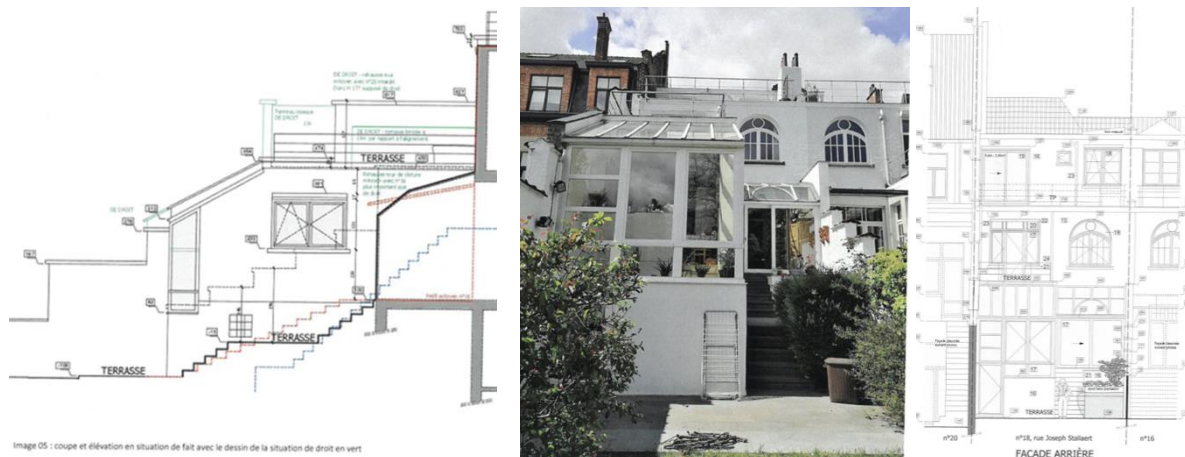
coupe et élévation en situation de fait avec le dessin de la situation de droit en vert
